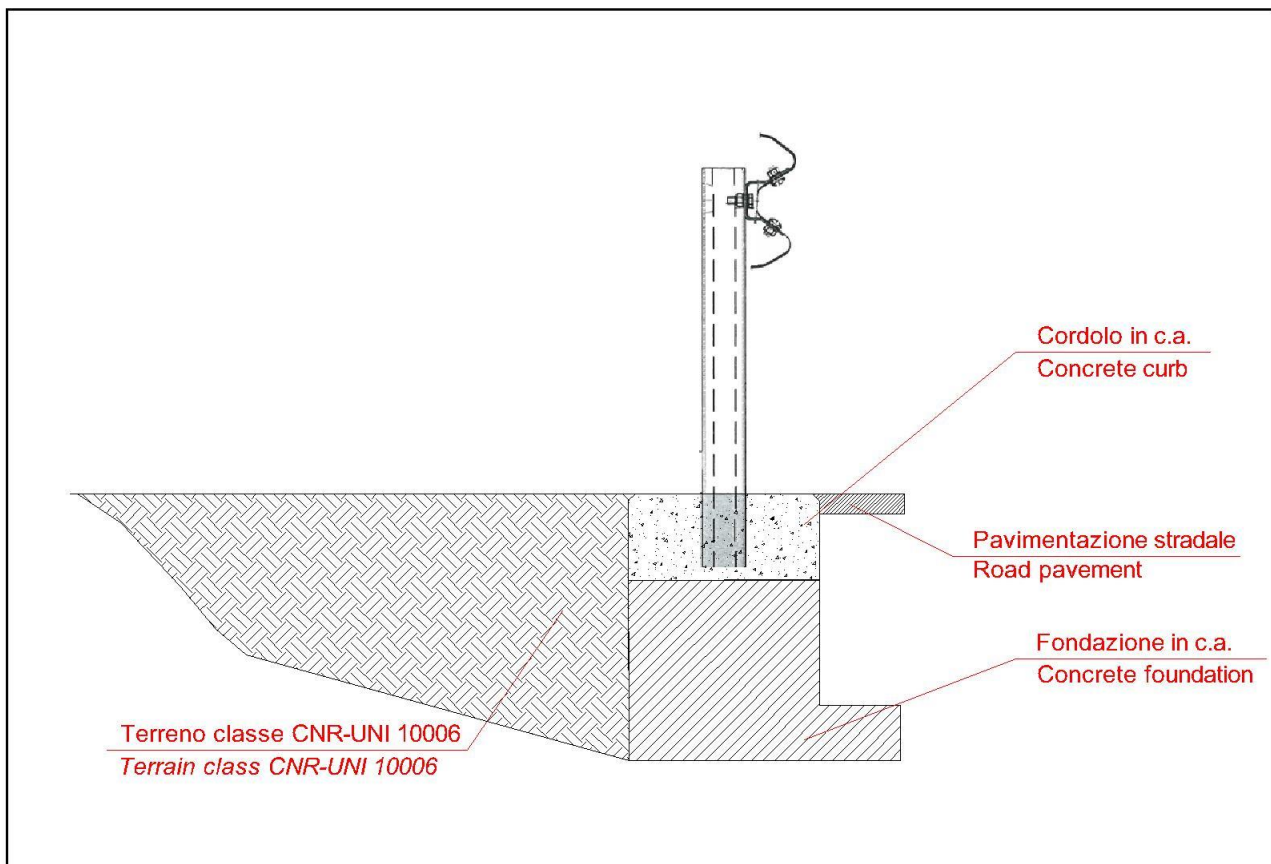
Figure 2 Sezione dell'installazione – The installation section
